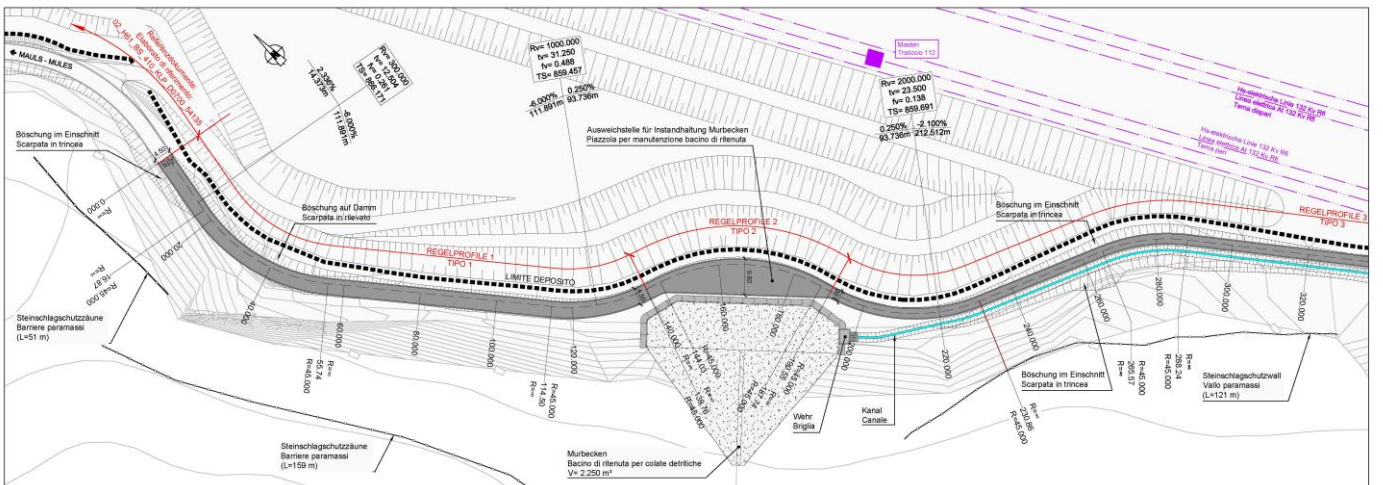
Lageplan Fahrradweg Baustelle Genauen 2 – Teil 1
